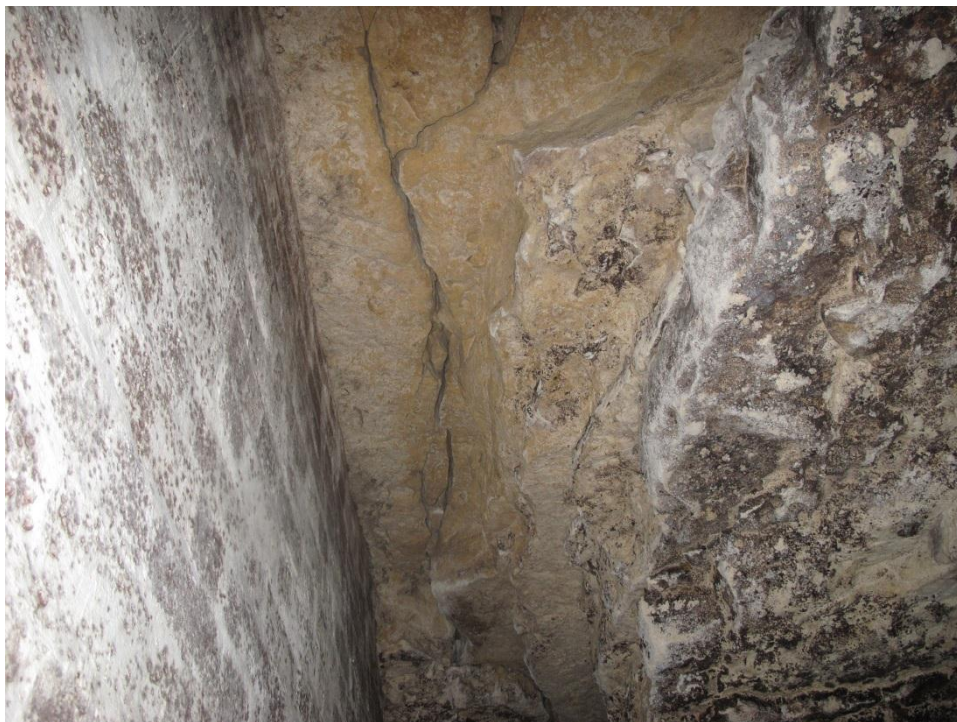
Zoom sur la fracture de décompression en fond de la cavité
